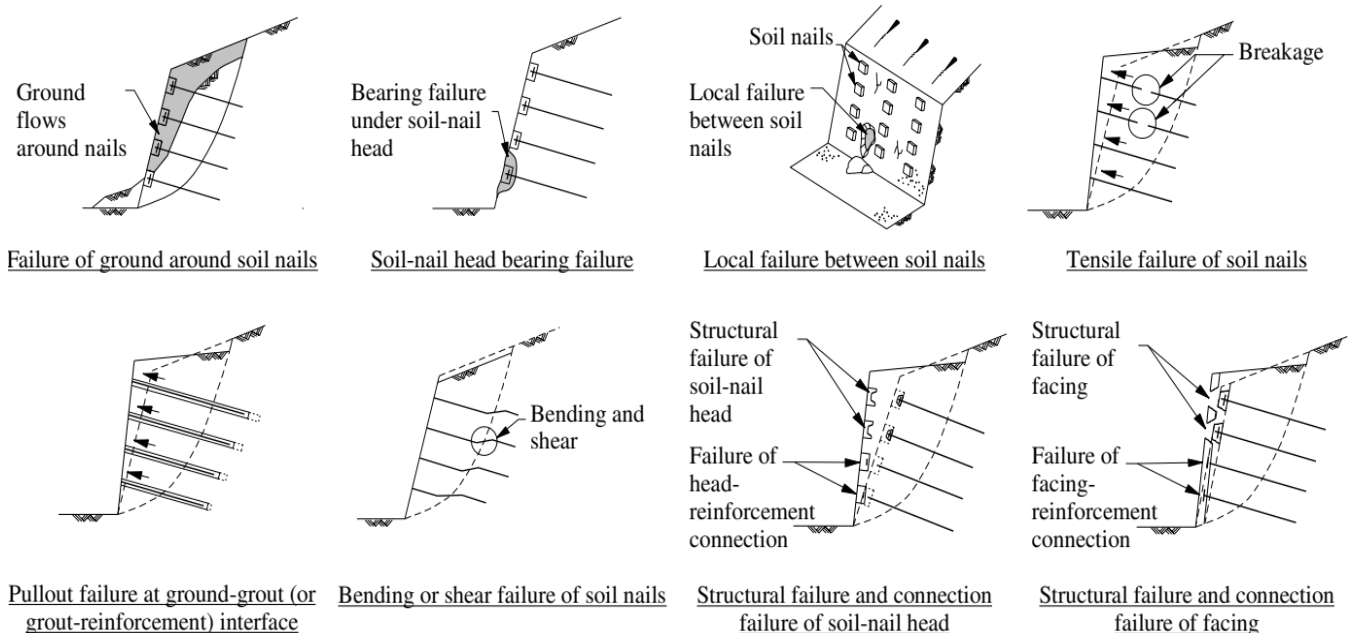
Principales modos de fallo interno de muros de soil nailing (Fuente: Geoguide 7 – Guide to Soil Nail Design and Construction (Pun, 2008))
